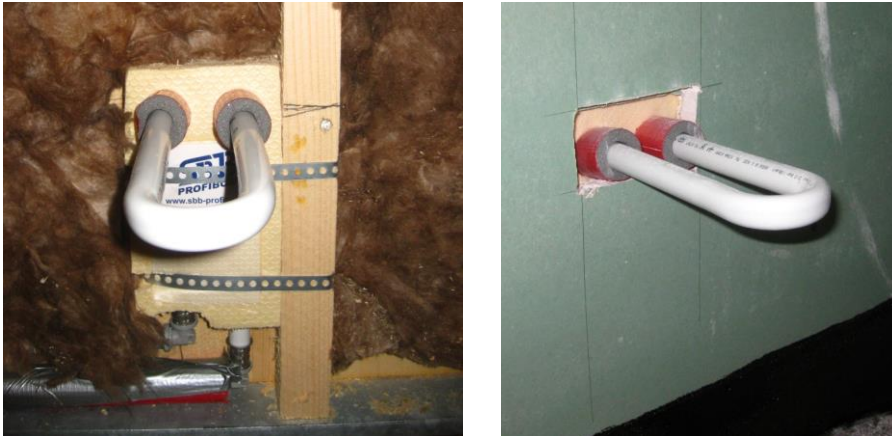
Montageelement für Heizkörper in der Vorsatzschale des Badezimmers (links) und Montagebox nach der Beplankung der GK - Wand (rechts)
